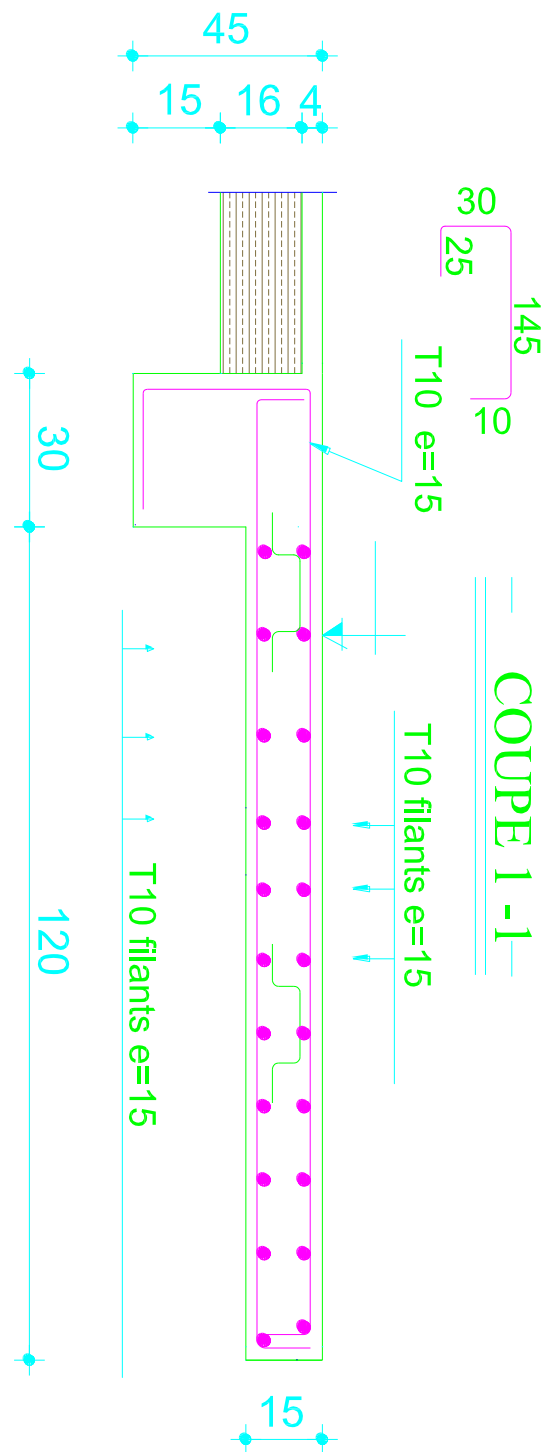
Coffrage et ferrailage du balcon Etage courante
